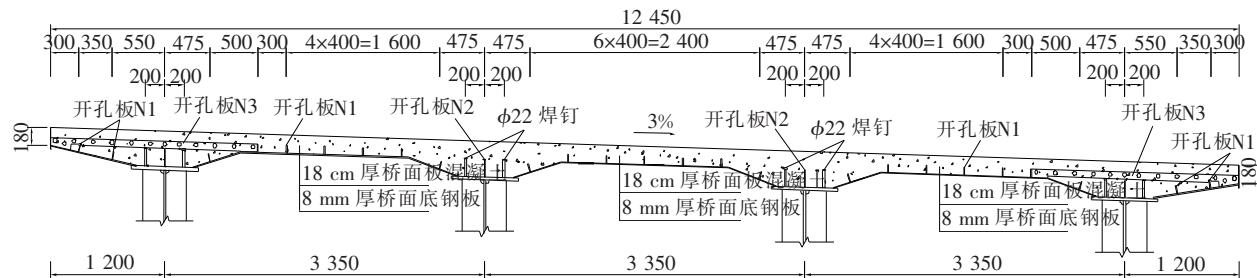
抗剪连接件及钢混组合桥面板剖面图(单位:mm)
